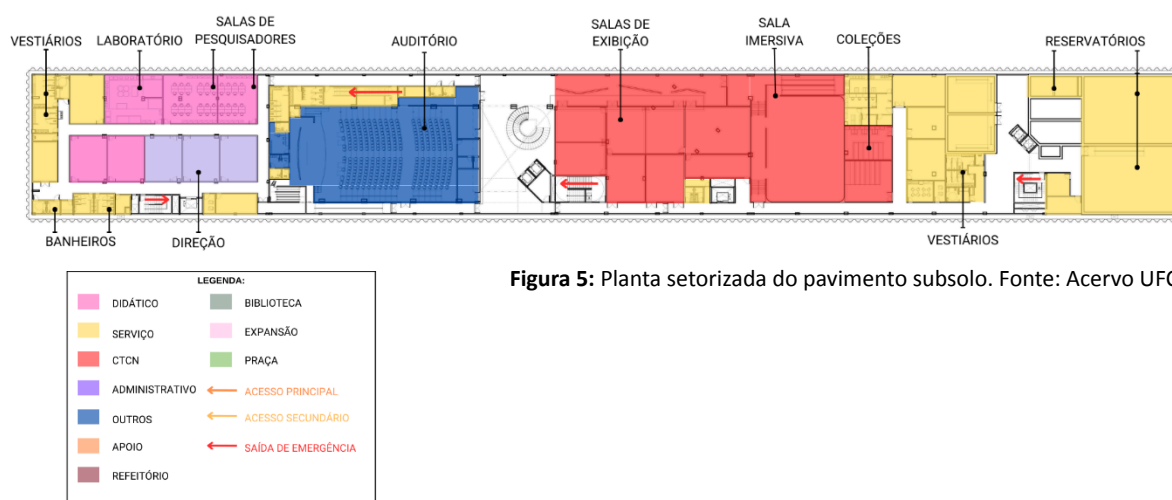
Planta setORIZADA do pavimento subsolo. Fonte: Acervo UFC
